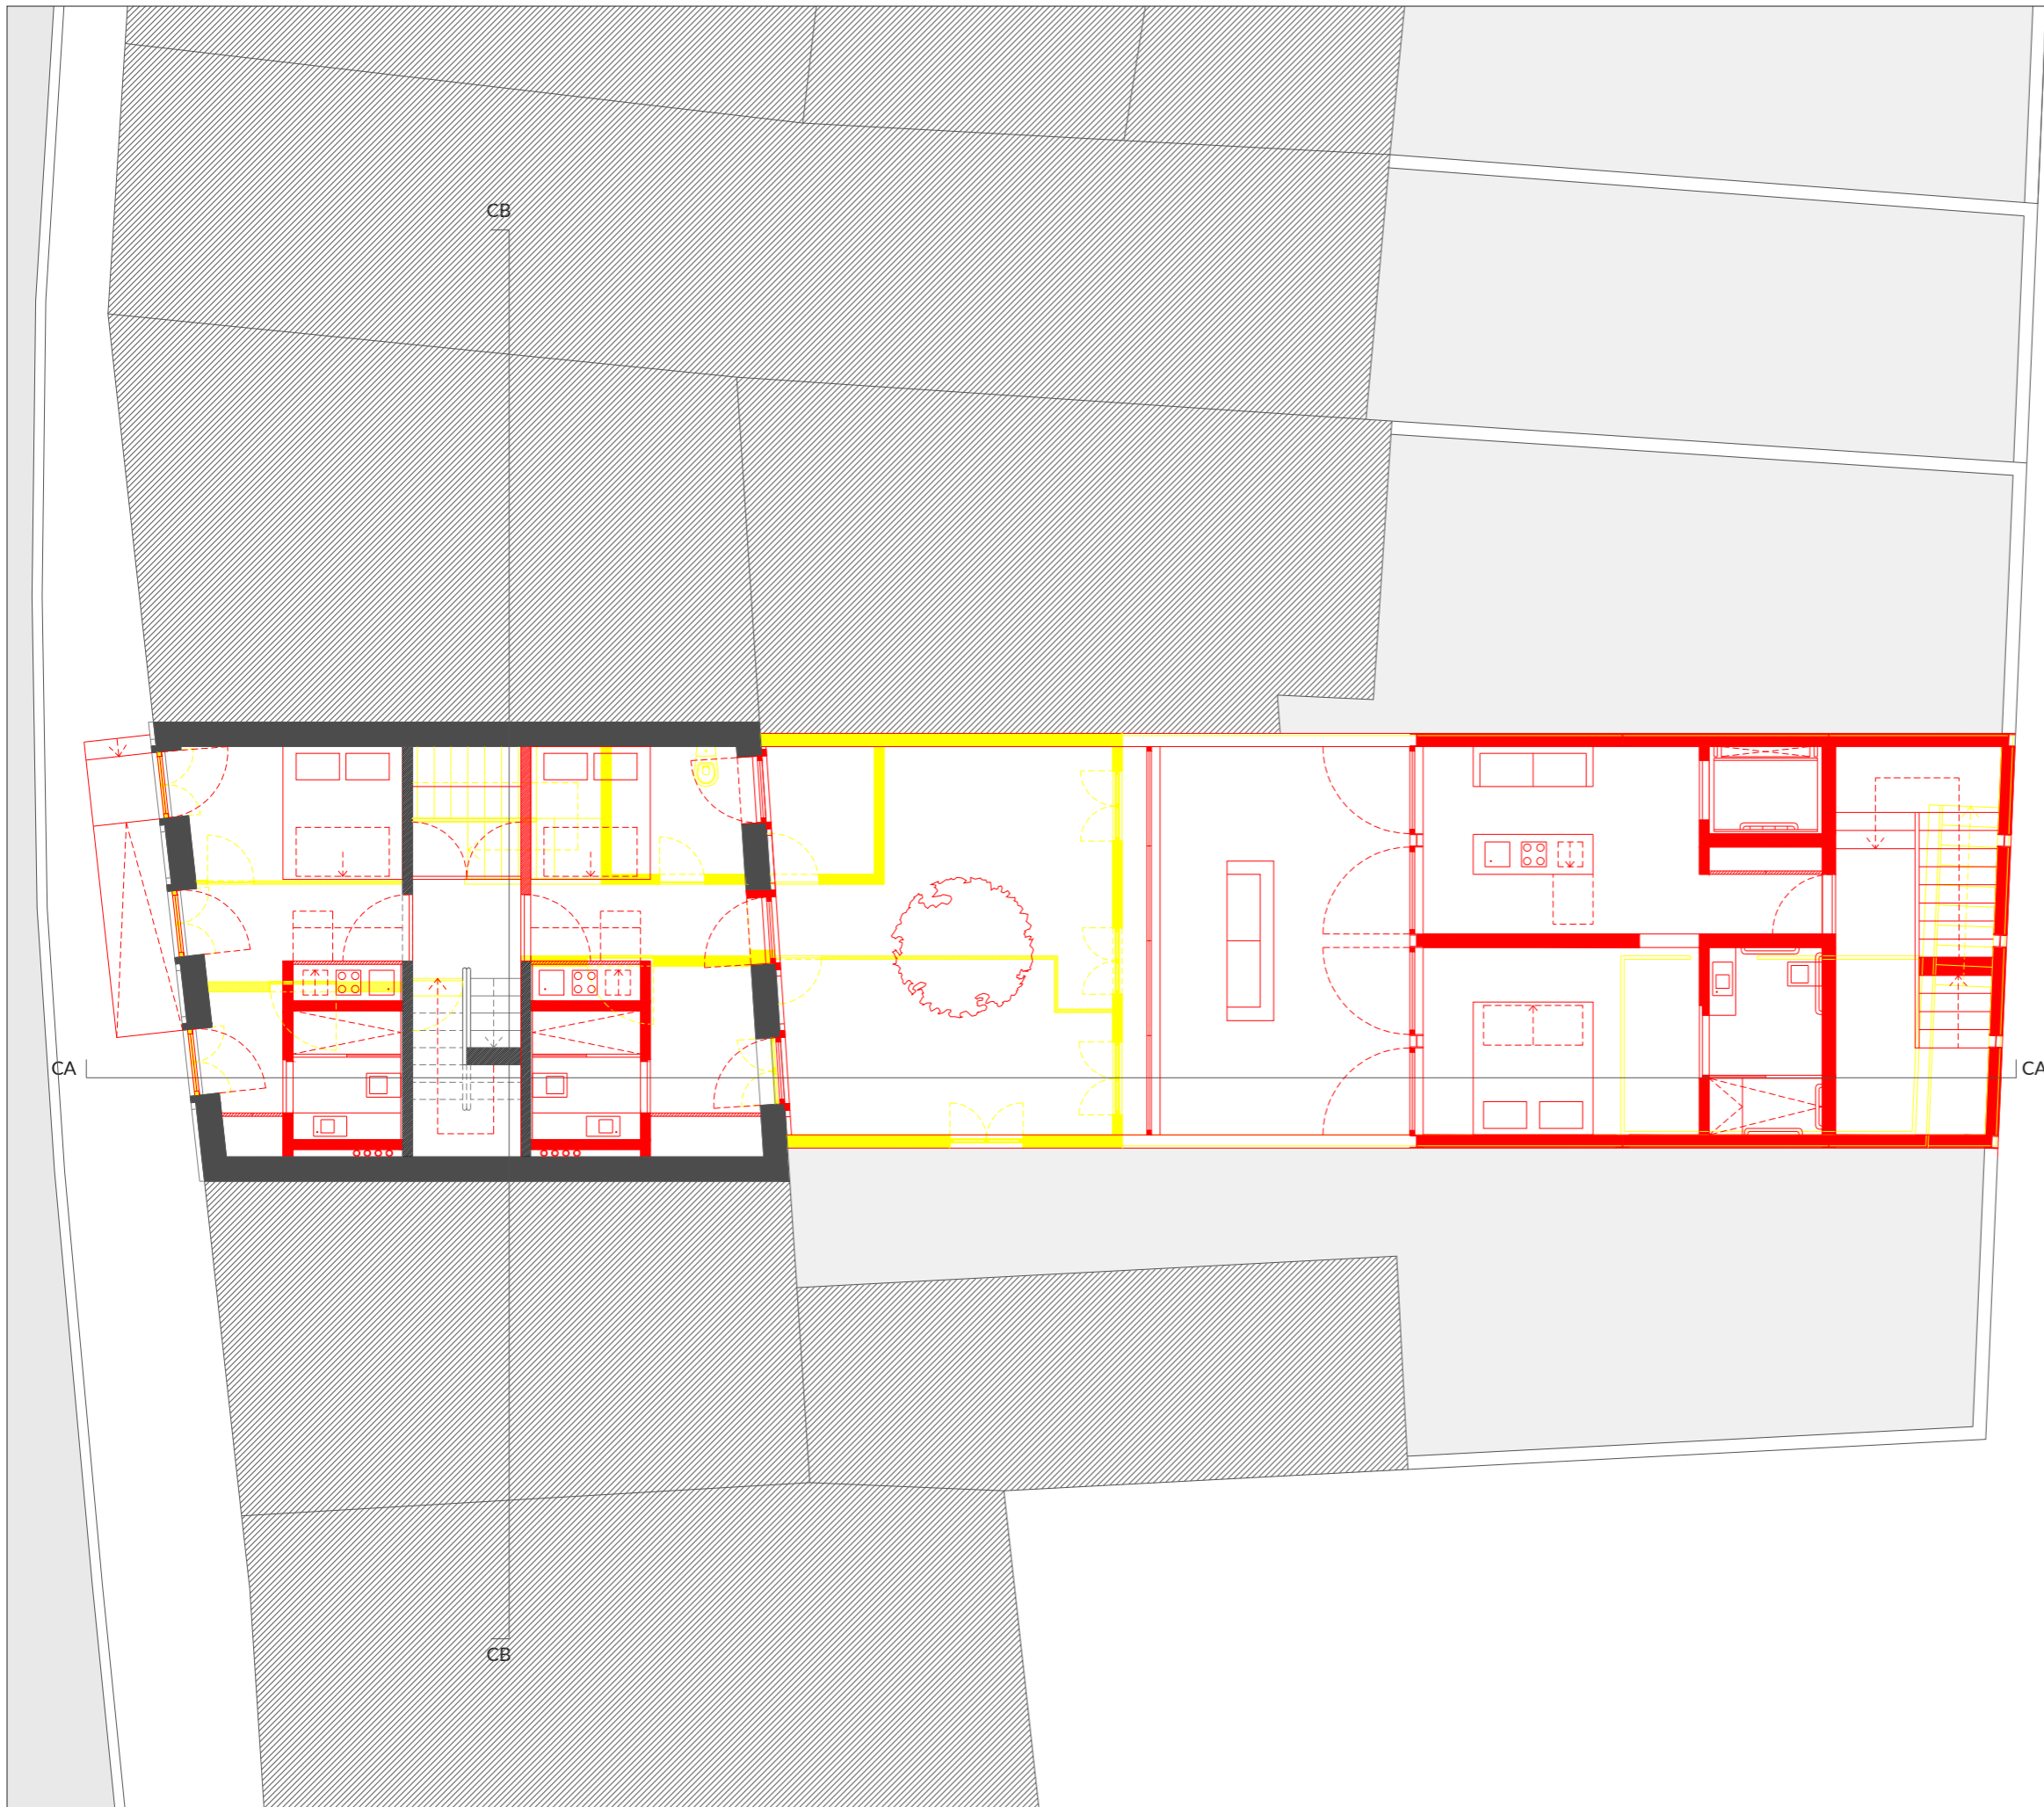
Planta do piso 2 | Vermelhos e amarelos
